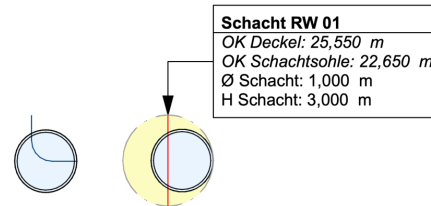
· Etikettierte Schachtsicht im Grundriss mit Fließpfeil und Objektdaten.
